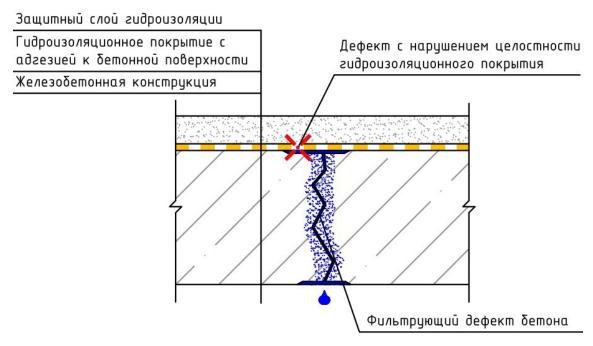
Дефекты гидроизоляционного покрытия с водопроявлениями через дефекты бетона
